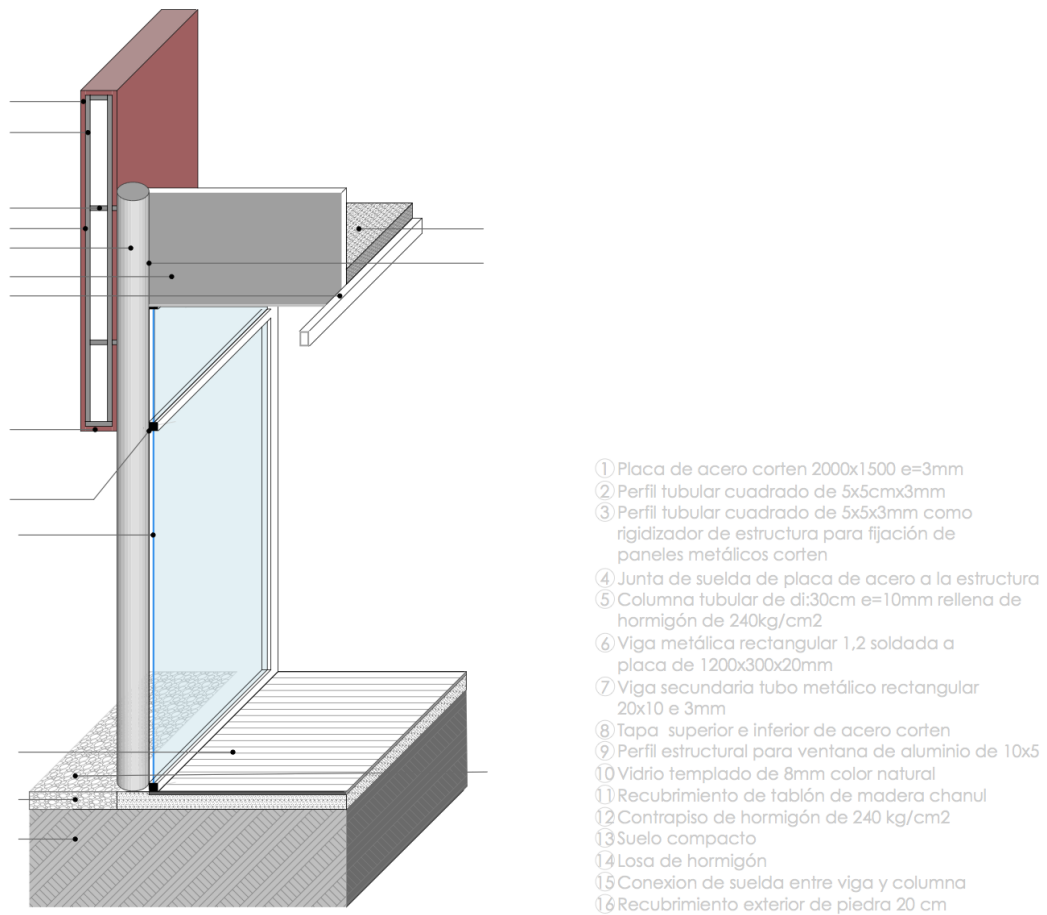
Detalle muro corten fachada de iglesia; Fuente: autor
